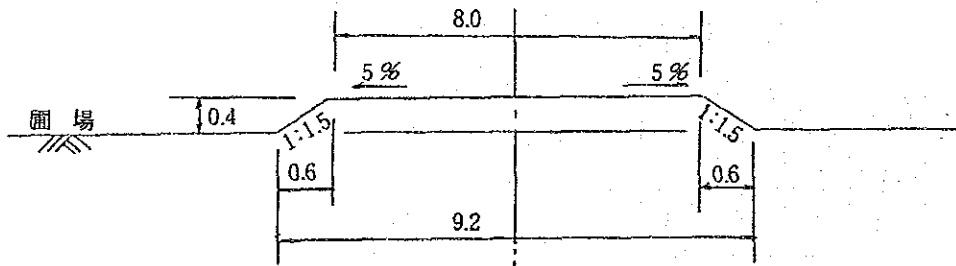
支線道路標準断面図 (タイプ3及び4) (単位: m)
